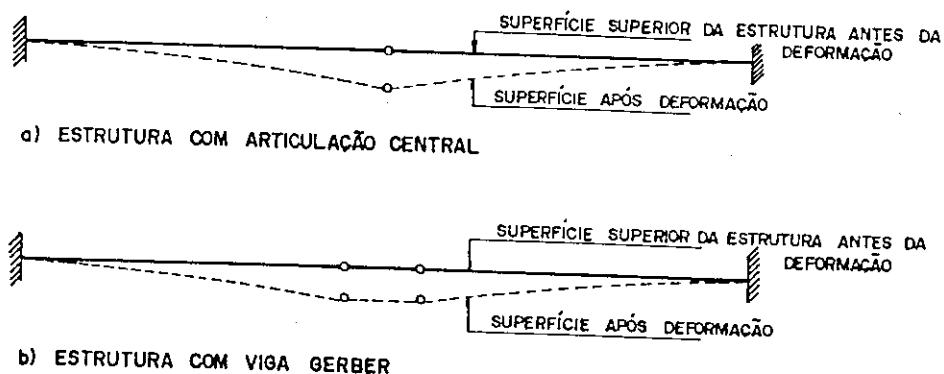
DEFORMAÇÃO DAS ESTRUTURAS COM ARTICULAÇÃO E VIGA GERGER
